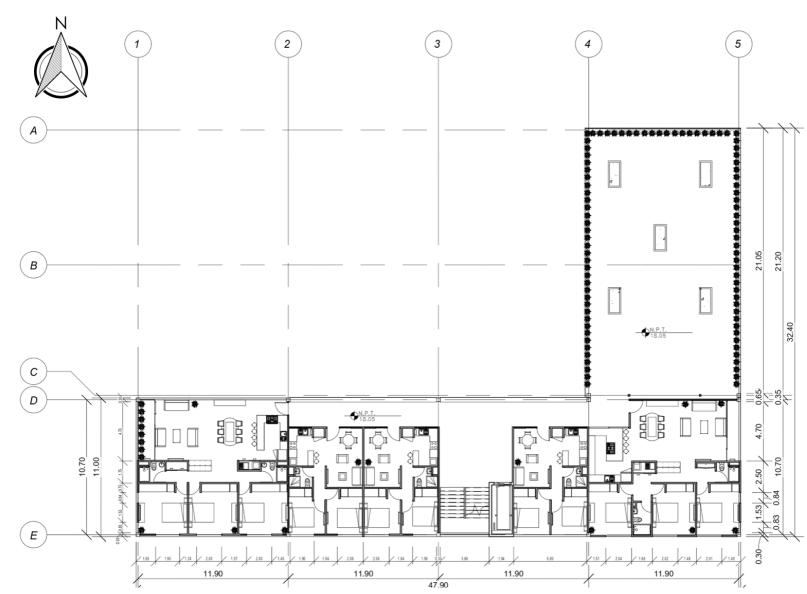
Propuesta final. Planta nivel seis. Elaboración propia. 2022
